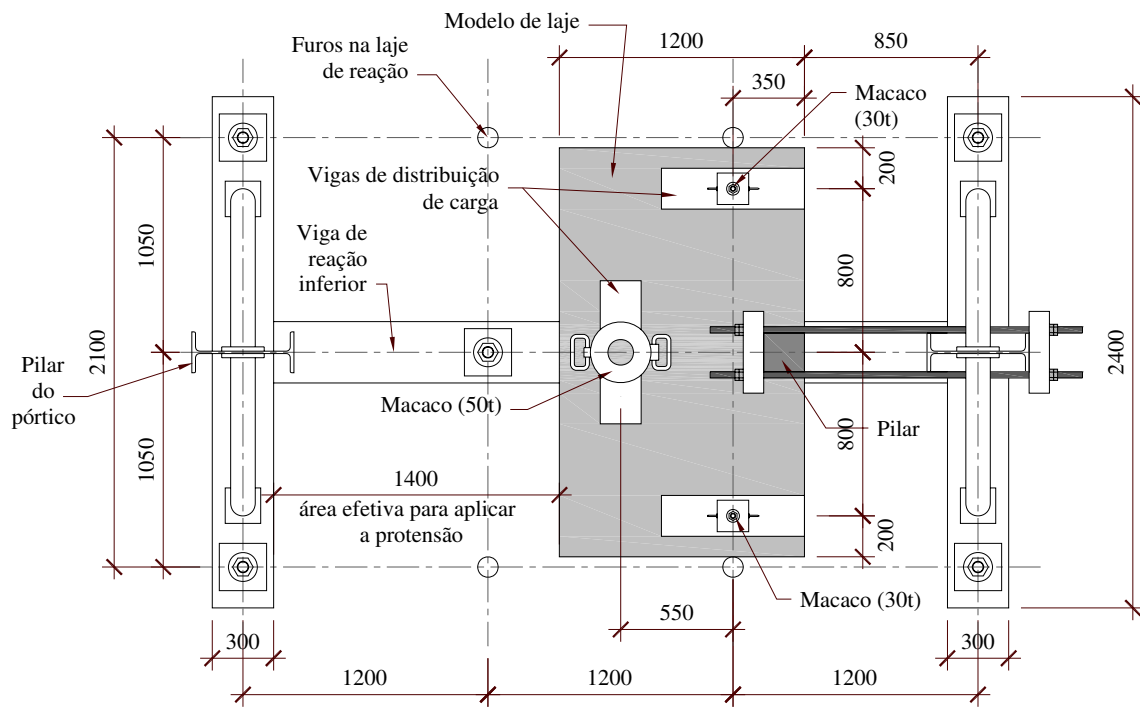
Planta e elevação do modelo de ensaios (mm)
